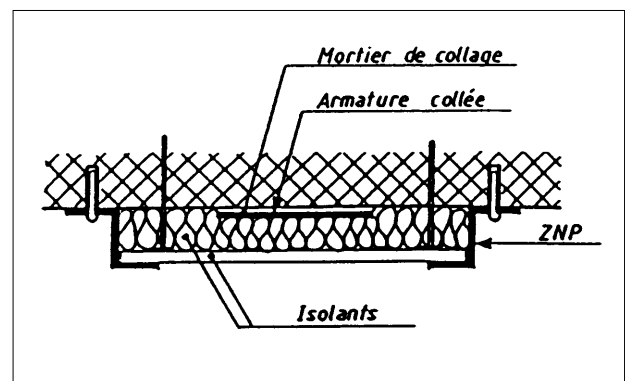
Exemple d'un revêtement de protection contre l'incendie.
